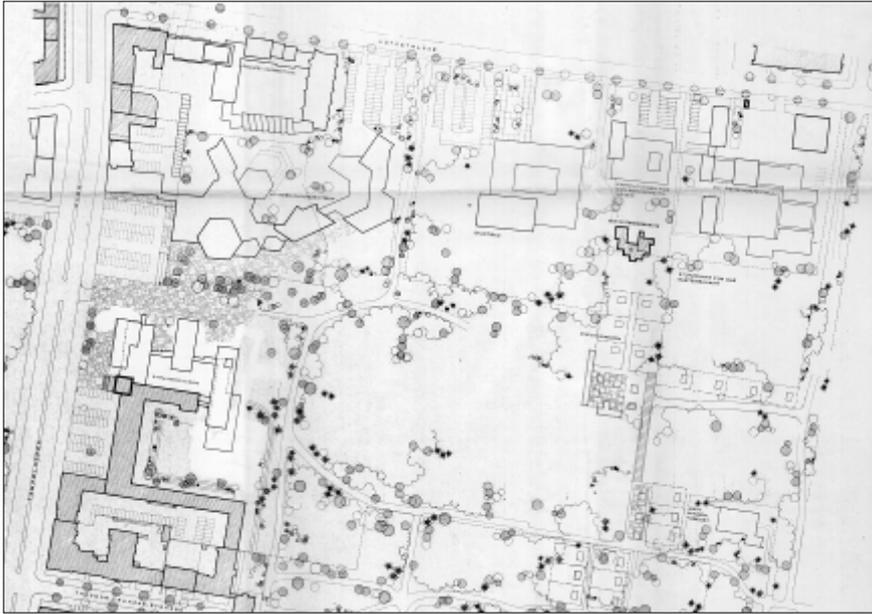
Städtebauliches Konzept "Zentrum Tempelhof", Entwurf: Stadtplanungsamt Tempelhof, 1964, Grundlage für den Bebauungsplan XIII-80 (ebda.)
